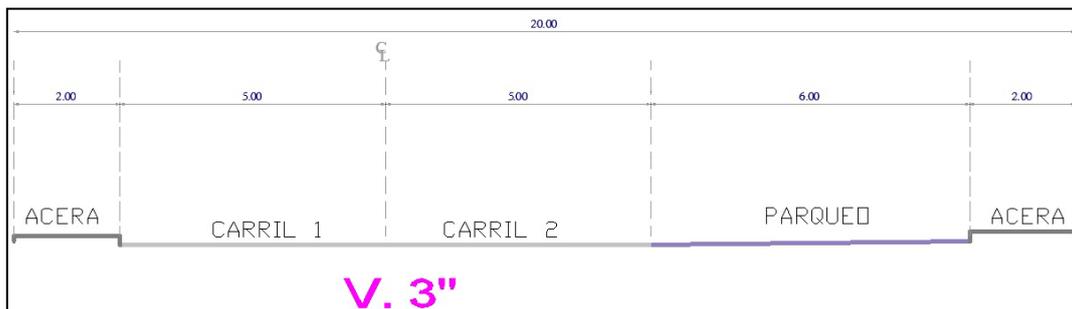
DETALLE DE LA VÍA V3''
